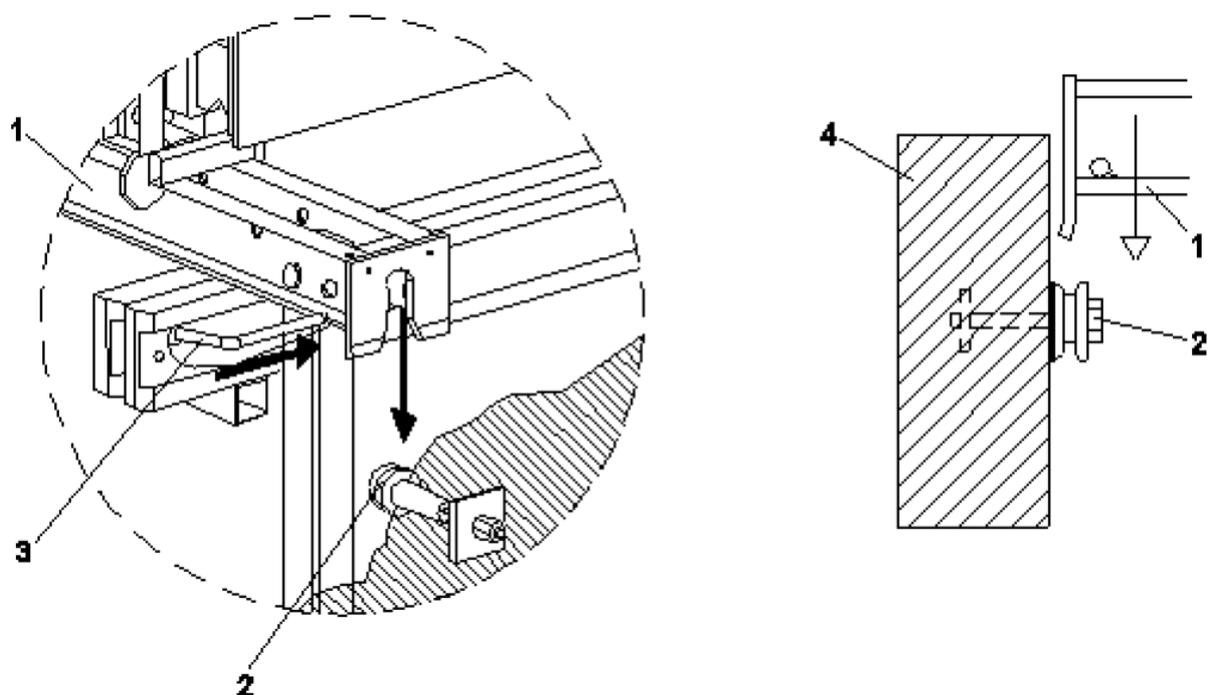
Схема устройства анкерного узла 1 – рабочие подмости; 2 – анкерный узел; 3 – страховочный элемент; 4 – монолитная стена
